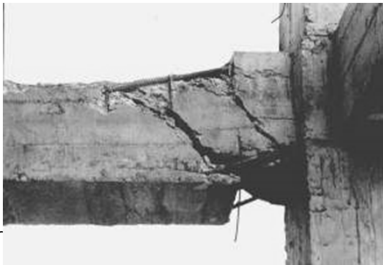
Distintos tipos de fisuras que aparecen en vigas de hormigón armado según ubicación y combinación de esfuerzos
